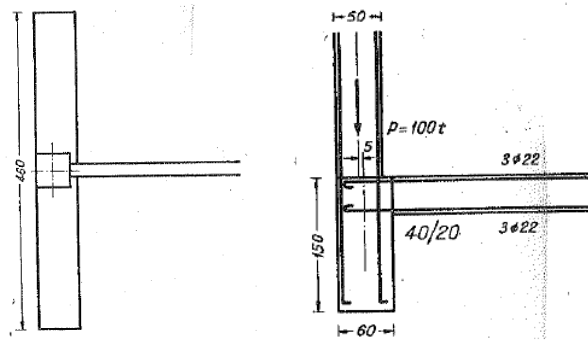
Zapata de medianería con viga centradora. Lahuerta [9]
